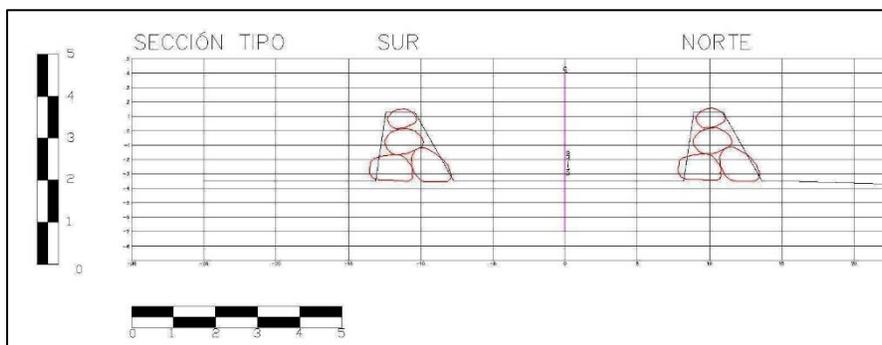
Secciones transversales de las estructuras arrecifales artificiales.
